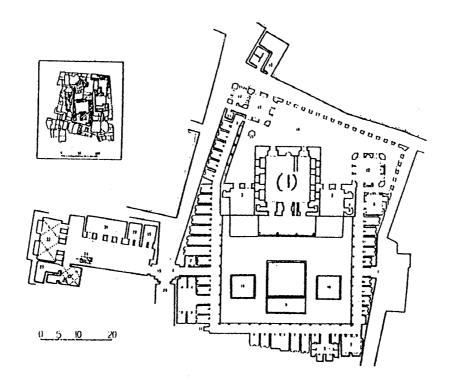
مسقط أفقي لمسجد قصر الحلابات . (عن : كريزول) .
